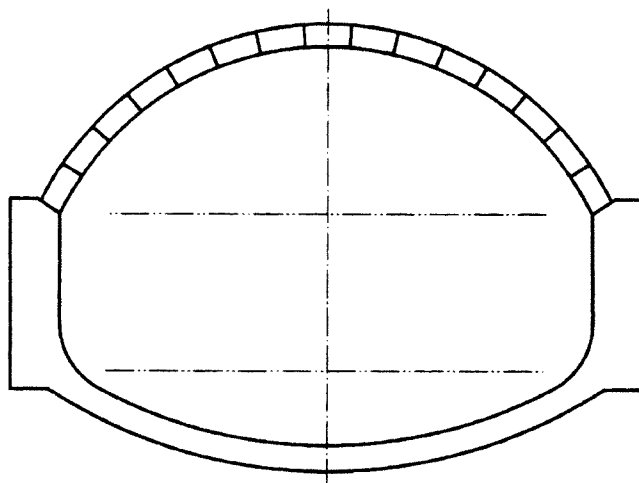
具有钢筋混凝土弧段的混凝土隧道
